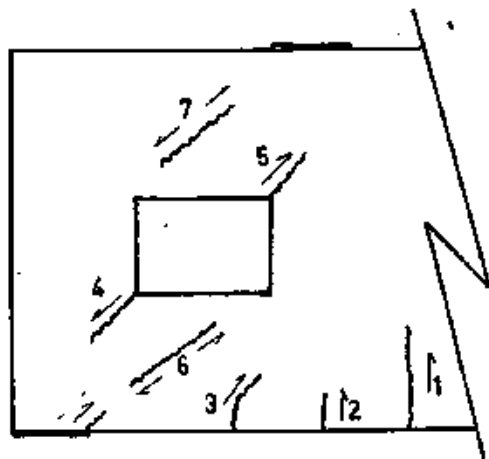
Fissuração de uma viga parede com furos
